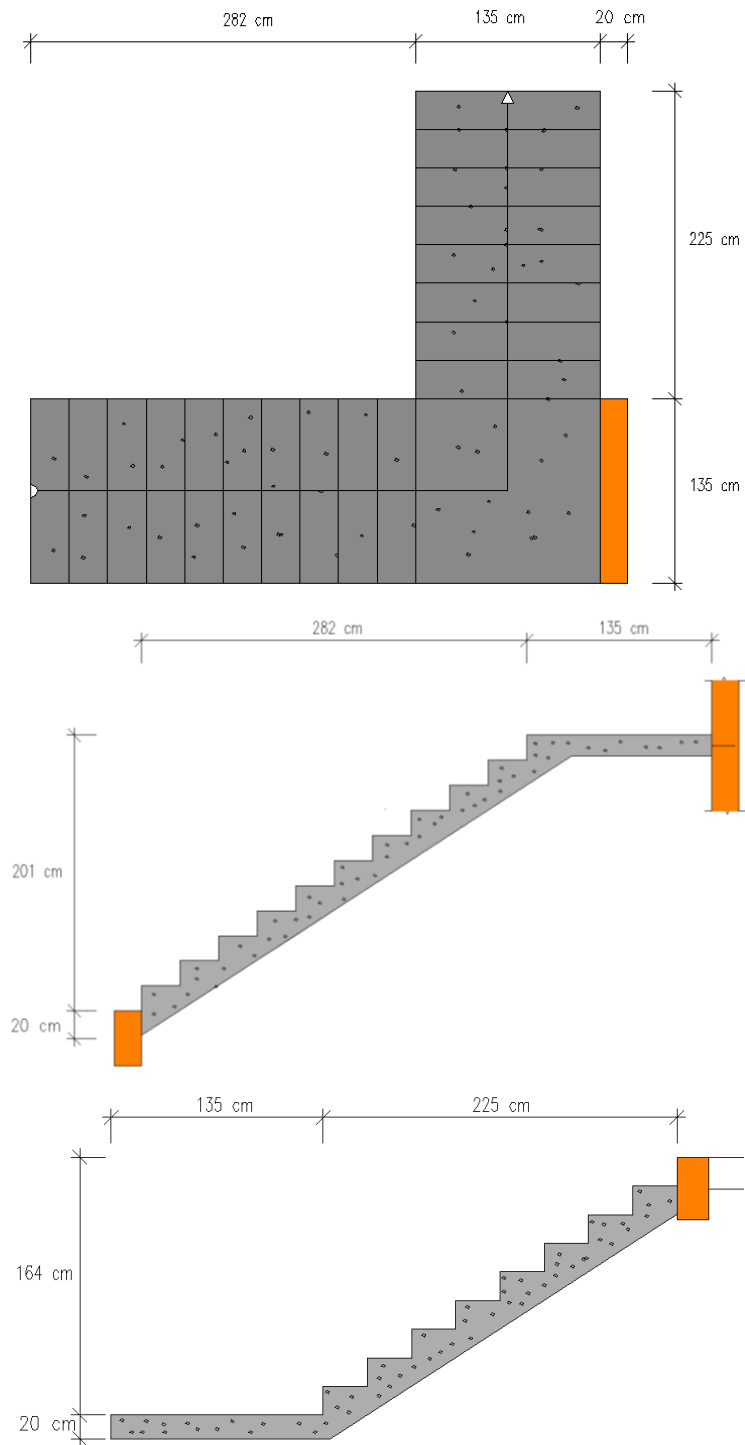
Geometría de la Escalera N°2; Elaboración Propia
